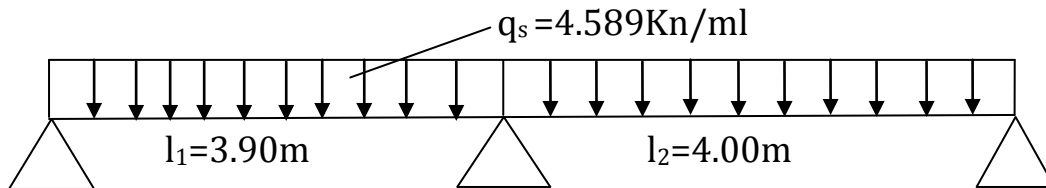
Schéma statique de la poutre continue reposant sur trois appuis.
